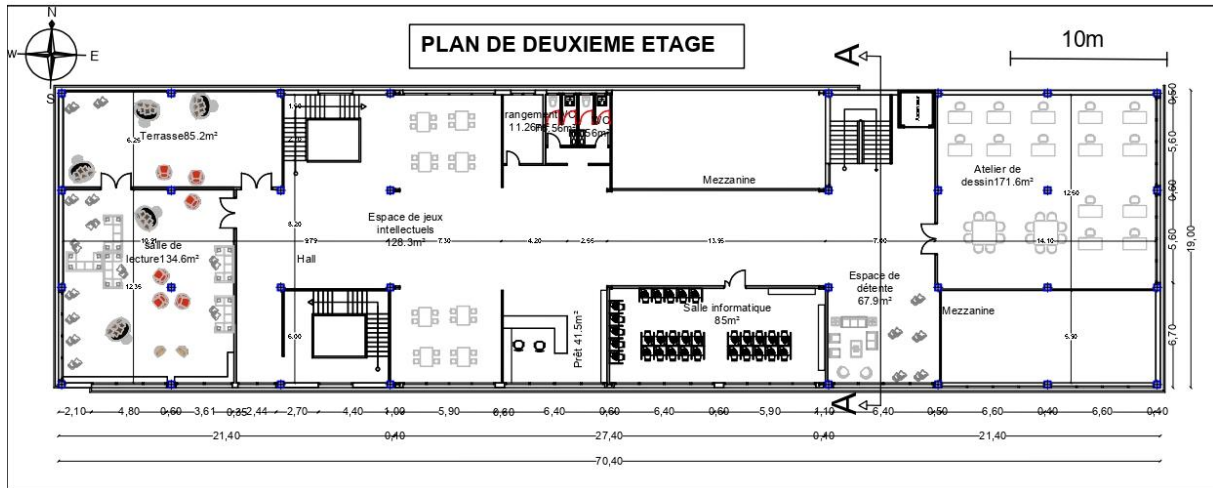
plan 2 eme étage de bloc C. Source : auteurs
